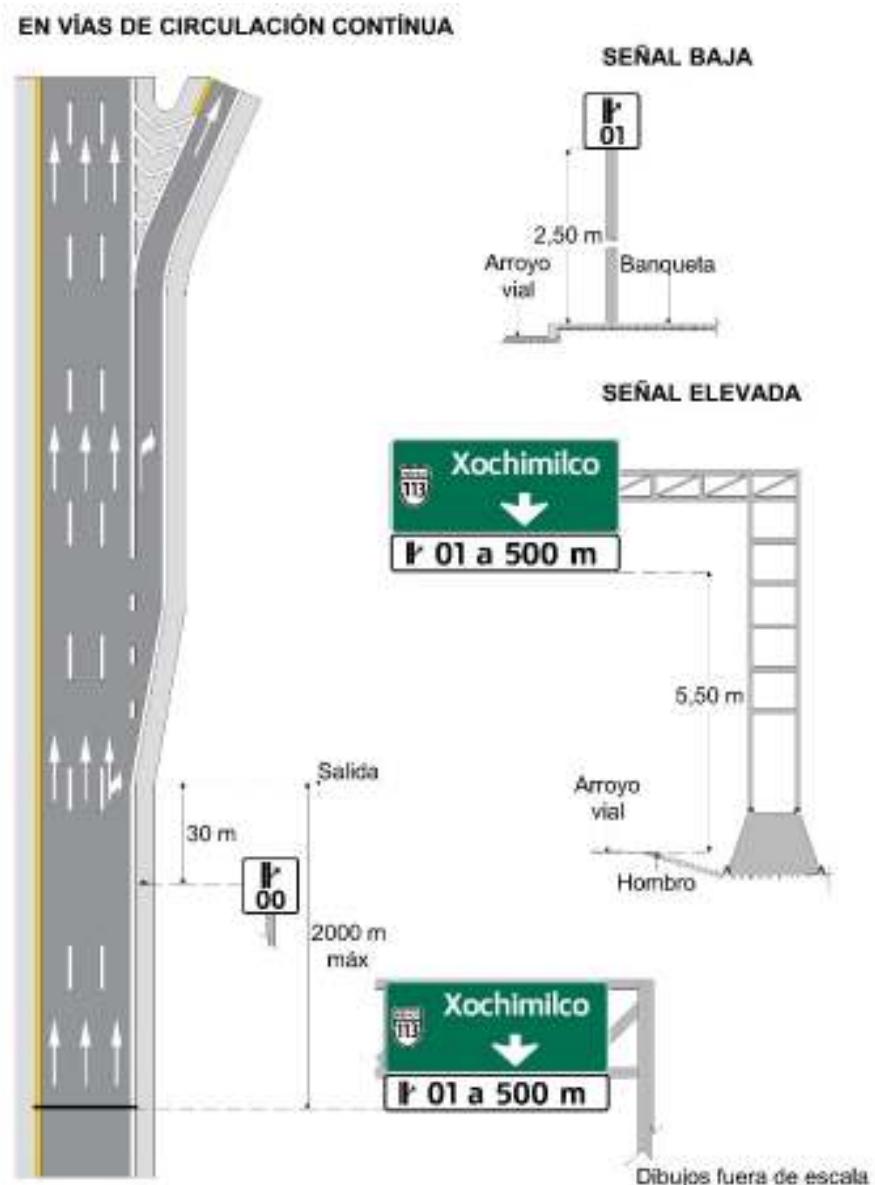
17 Ubicación de señales de salida baja y elevada
